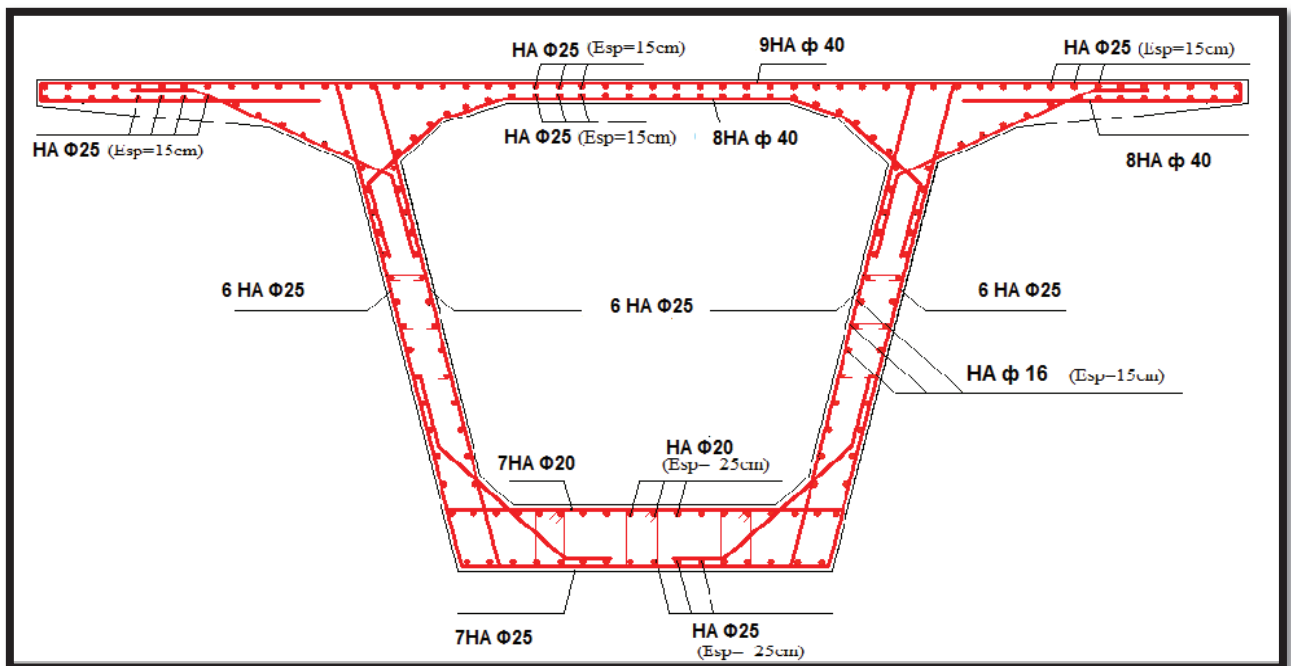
Schéma du Ferrailage du voussoir près de la pile
